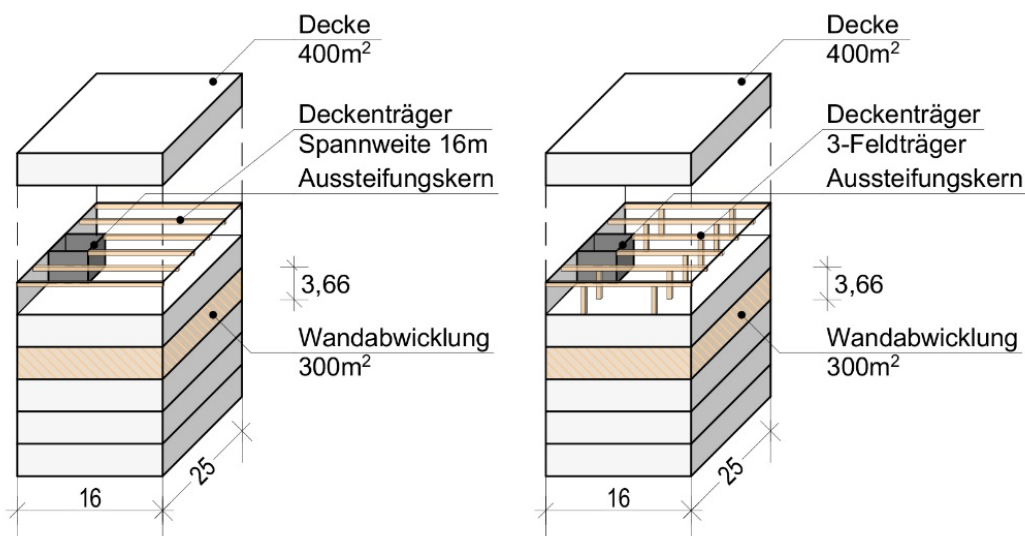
«Statische Gebäudegrundformen» kreislauffeffektiven Bauens (schematische Darstellung). Links: Freier Grundriss / Einraumsystem als z. B. Aufstockung eines Gebäudebestandes oder auch Hallenbauten; rechts: Skelettbau als z. B. mehrgeschossiger Neubau [4]
